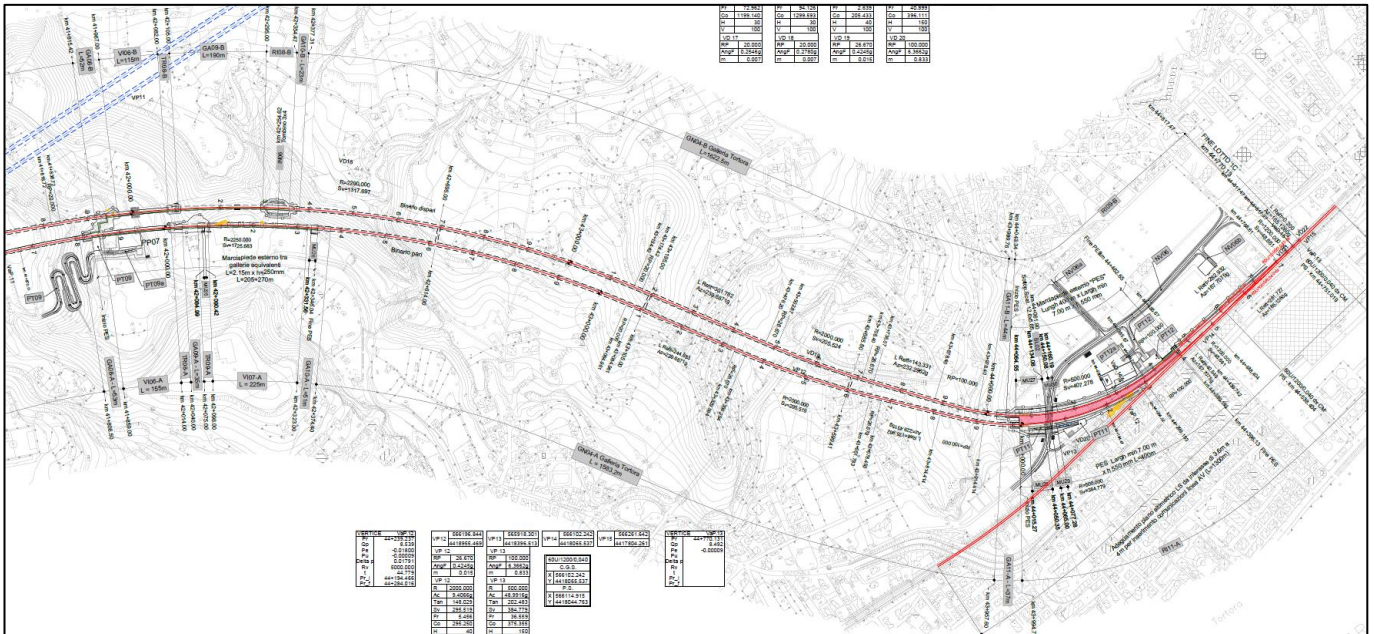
Planimetria di progetto VI05 da km 41+859 al km 44+770 BP
